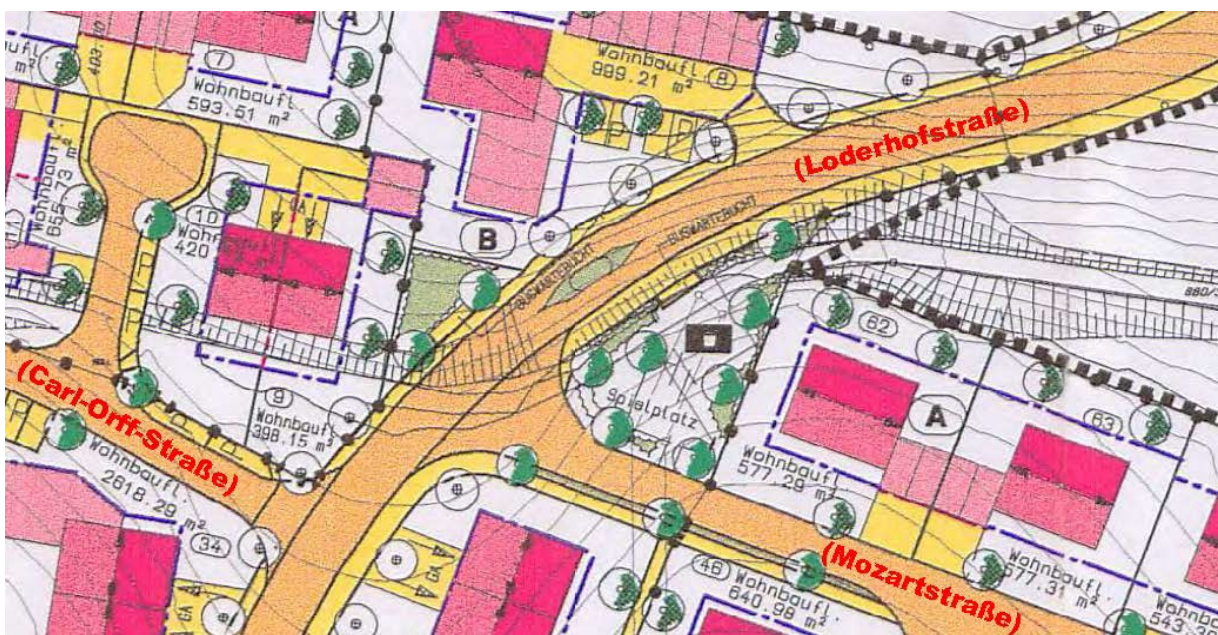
Ausschnitt Mitte im Bereich der Loderhofstraße aus dem Lageplan des rechtsgültigen Bebauungsplans „Loderhof BA III“ (ohne Maßstab)
